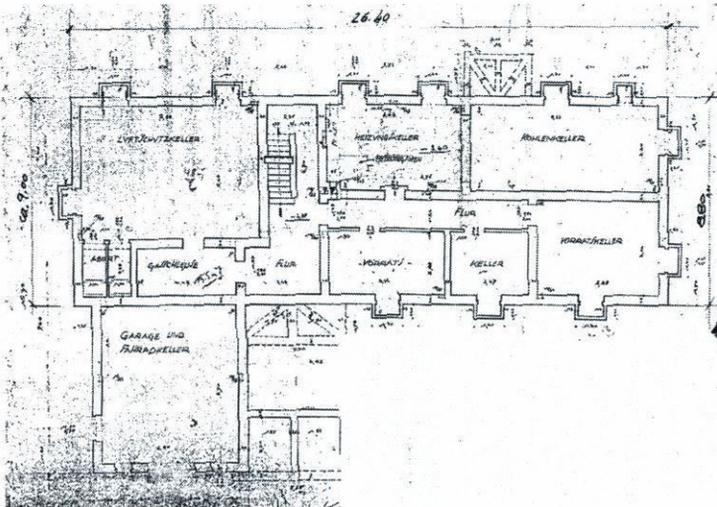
HJ-Heim Oberaußem, Grundriss Kellergeschoss.
